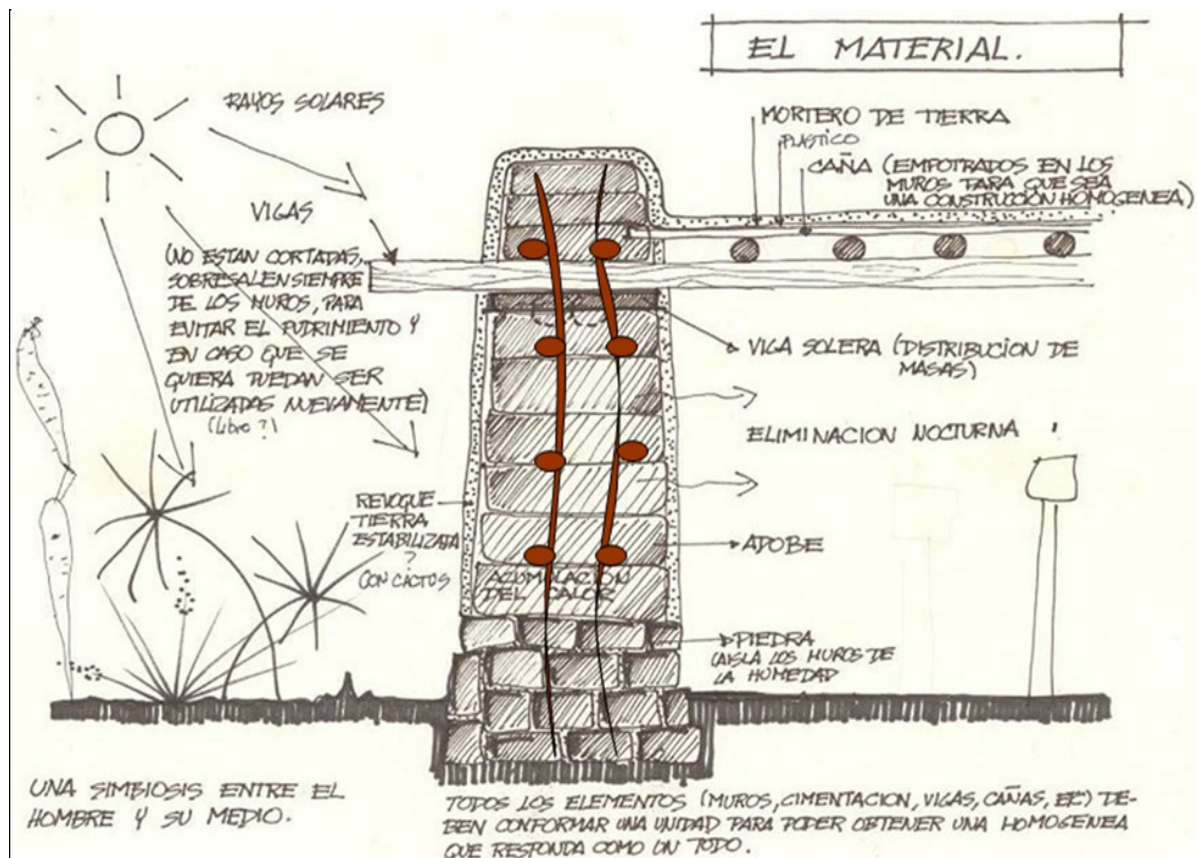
Corte esquemático de muro y cubierta sismo-resistente, construcción con tierra.
